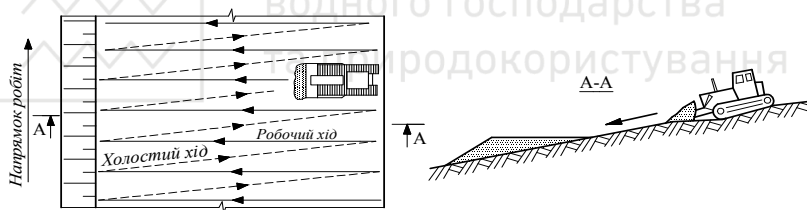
Схема розробки полиці на схилах поперечними проходами бульдозера
